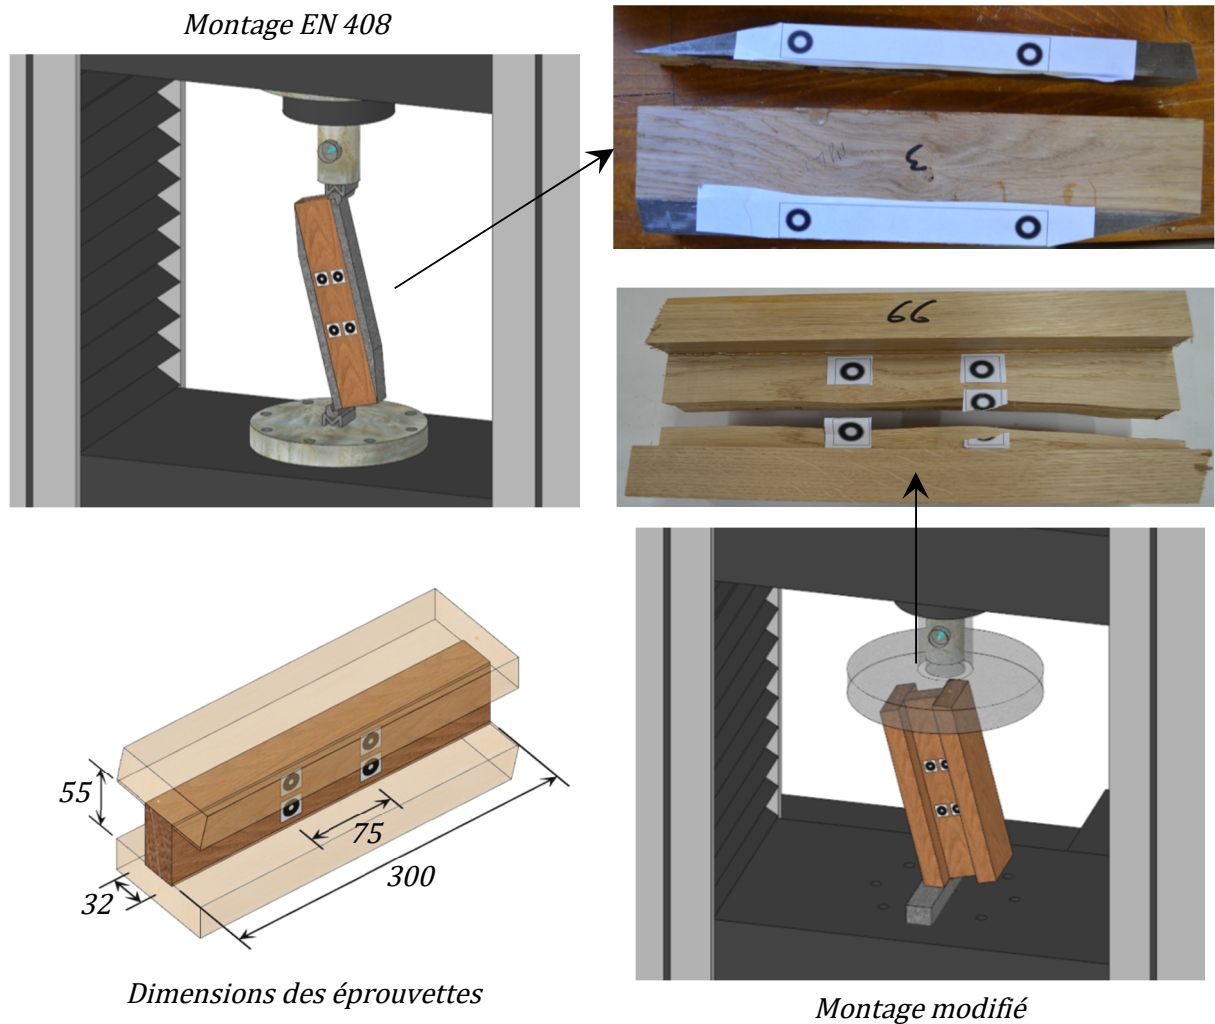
Montage de cisaillement sur la machine d'essais universelle.
